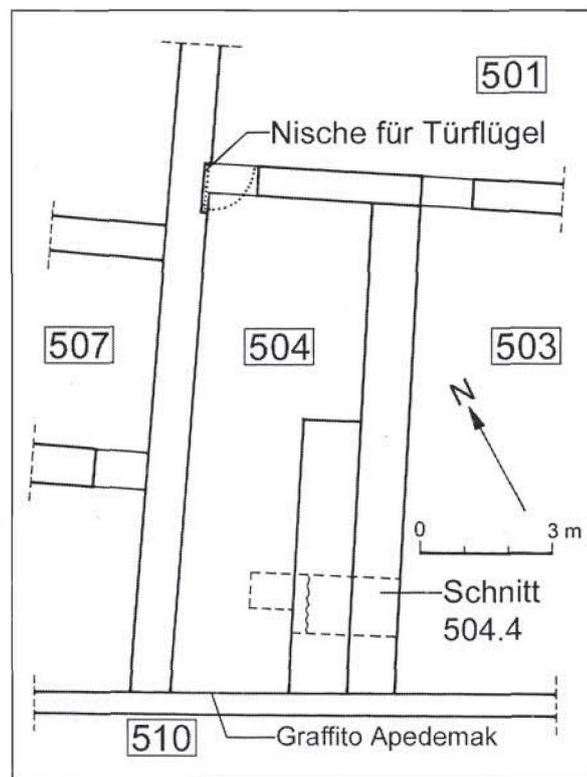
Grundriss Raum 504 mit Lage des Schnittes 504.4 (Entwurf: D. Eigner – Zeichnung: I. Säuberlich).
